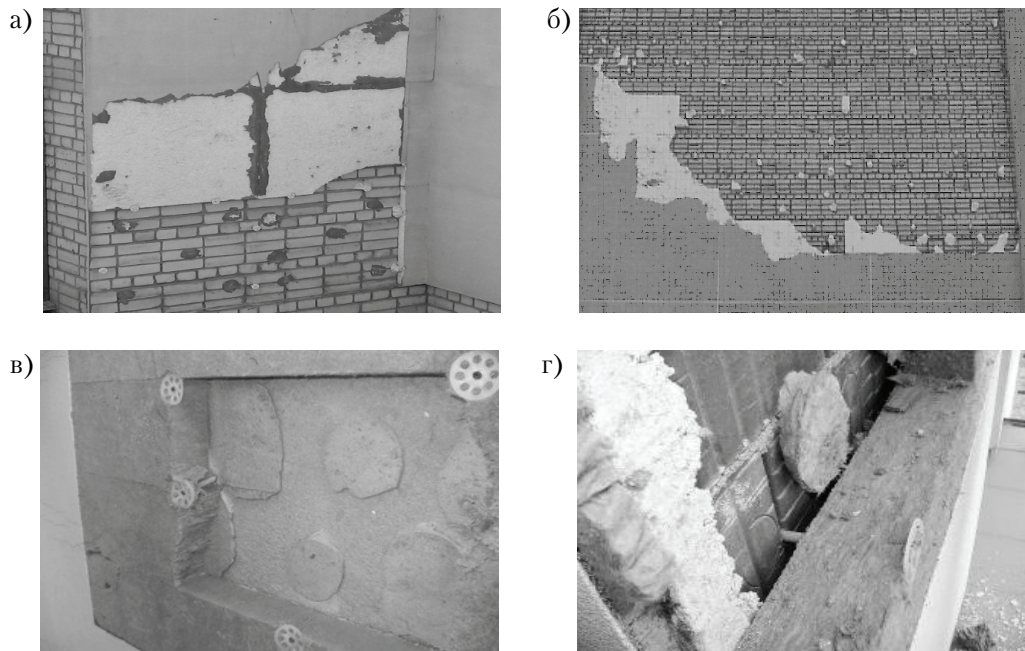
Фрагменты разрушенной теплоизоляции на фасадах жилых зданий, утепленных пенополистирольными (а, б) и минераловатными плитами (в, г).
